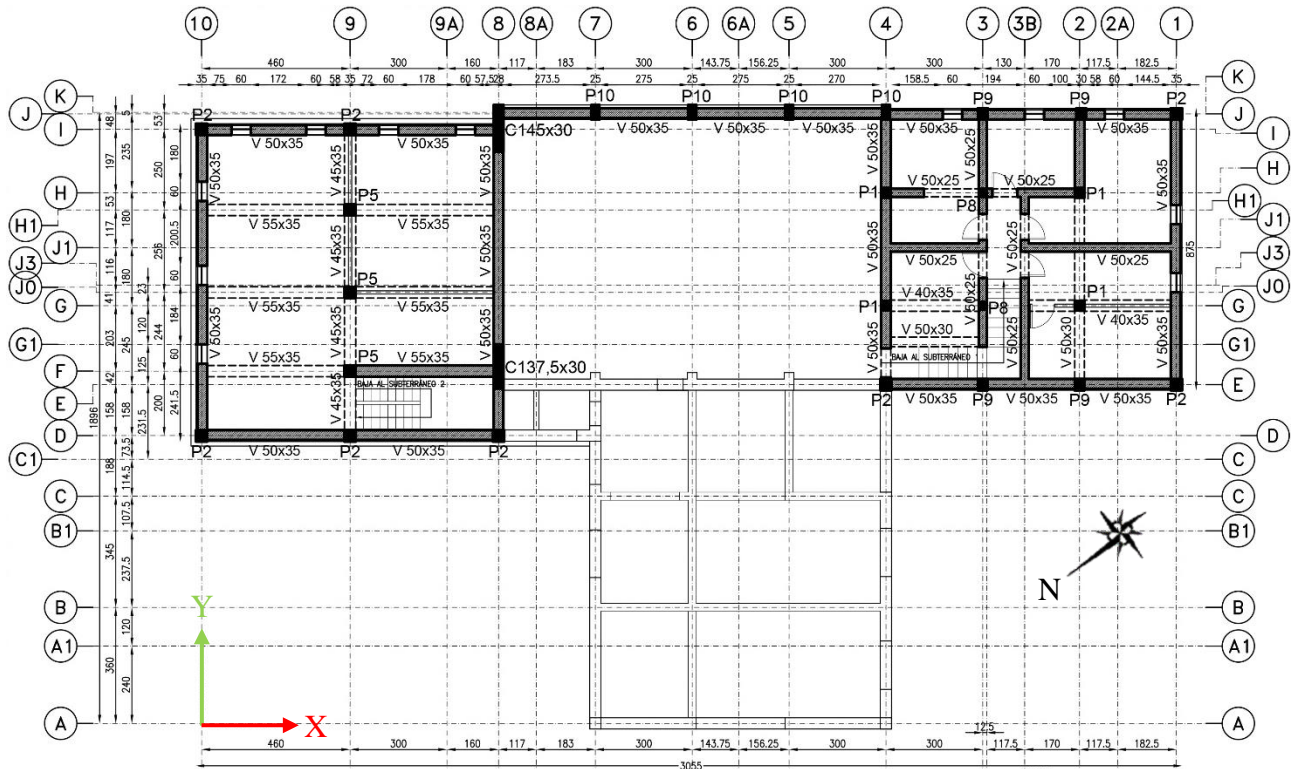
Planimetría del subterráneo del edificio DIDECO.
